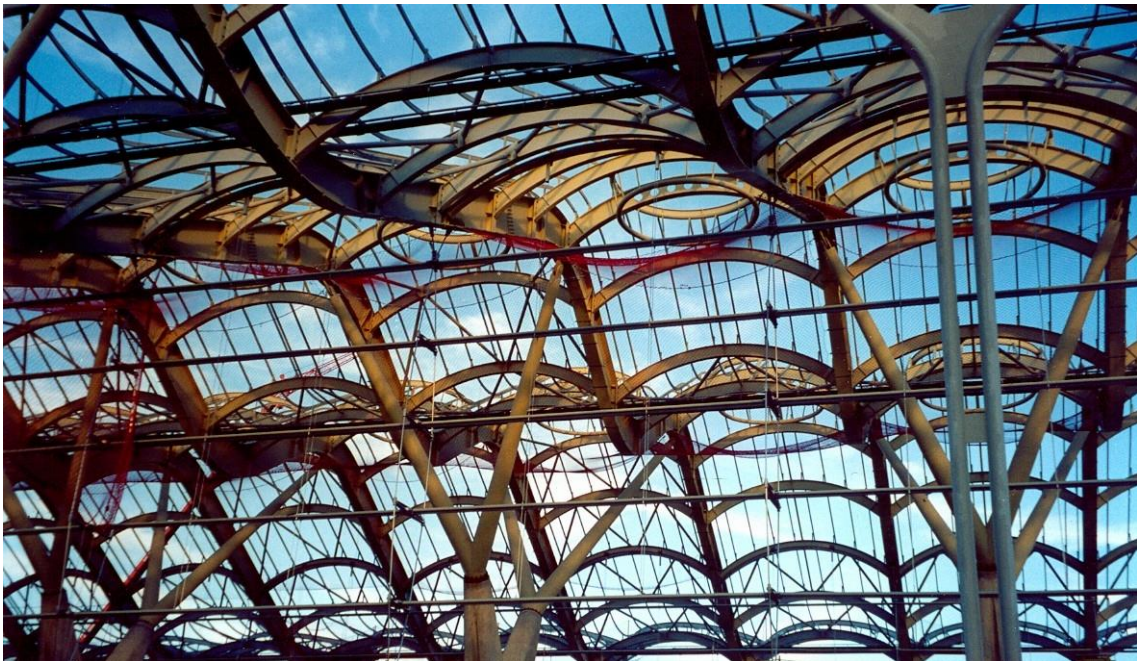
| Vista interior de la terminal en construcción. (Horta Coslada)
